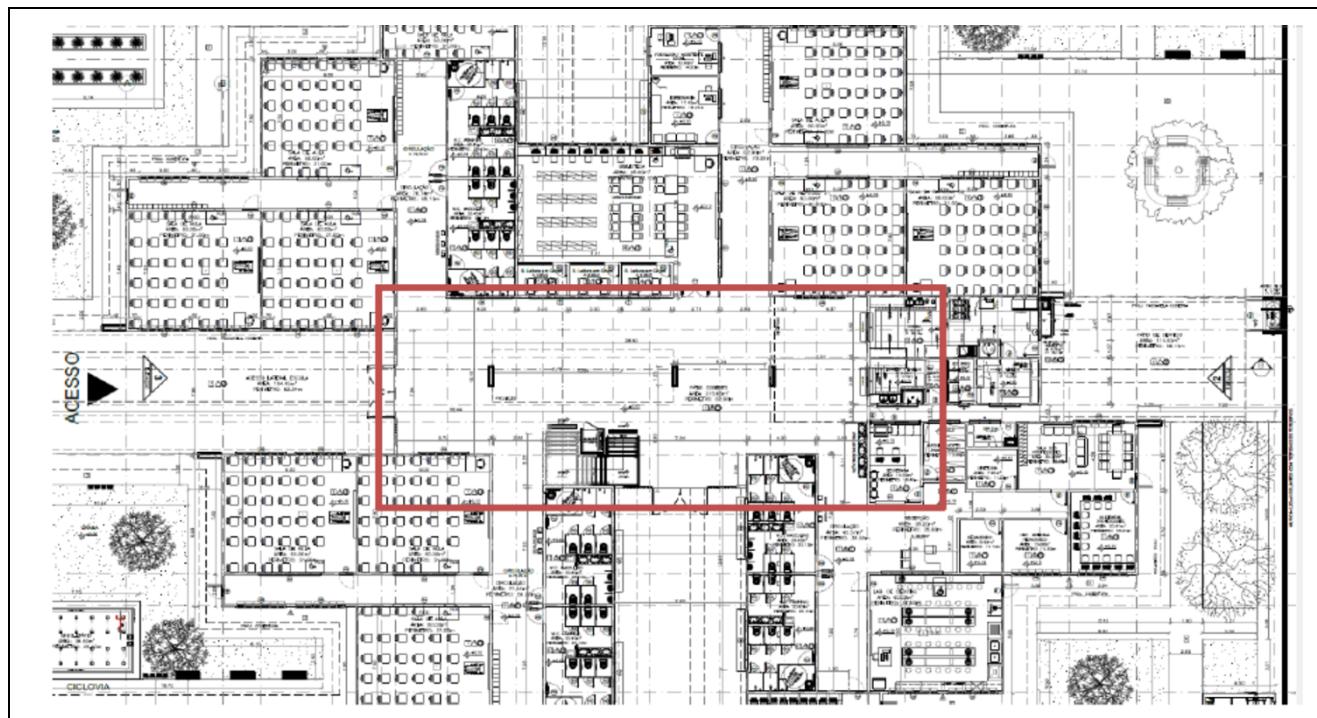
Planta baixa do projeto do Complexo Educacional da Escola Sustentável Tucandeira. Fonte: SEMED
